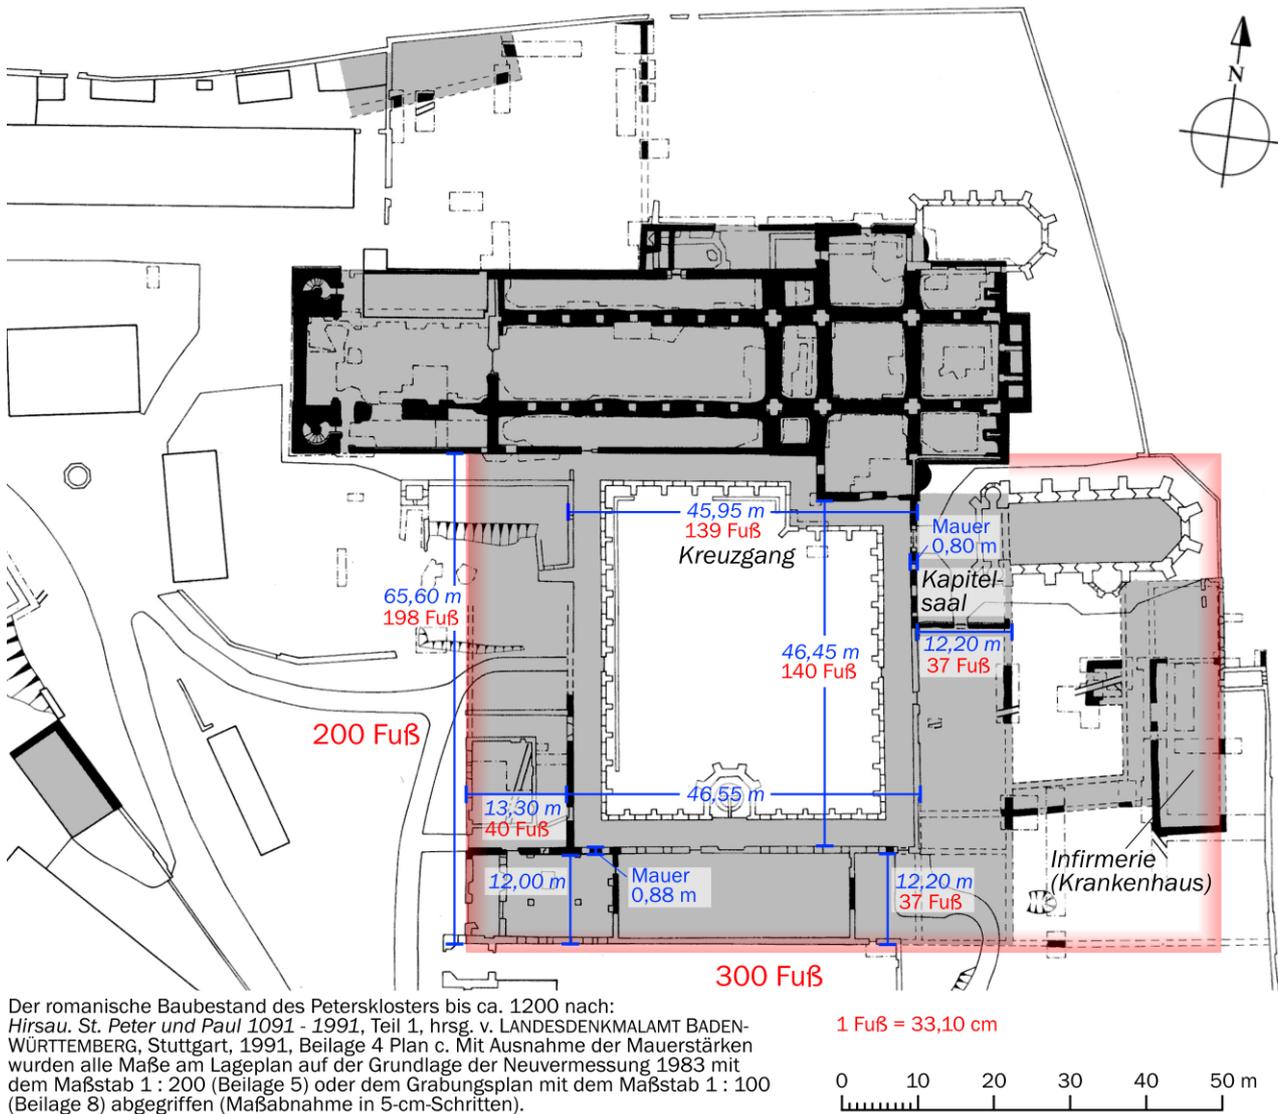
Grundriss des Petersklosters mit dem romanischen Baubestand
